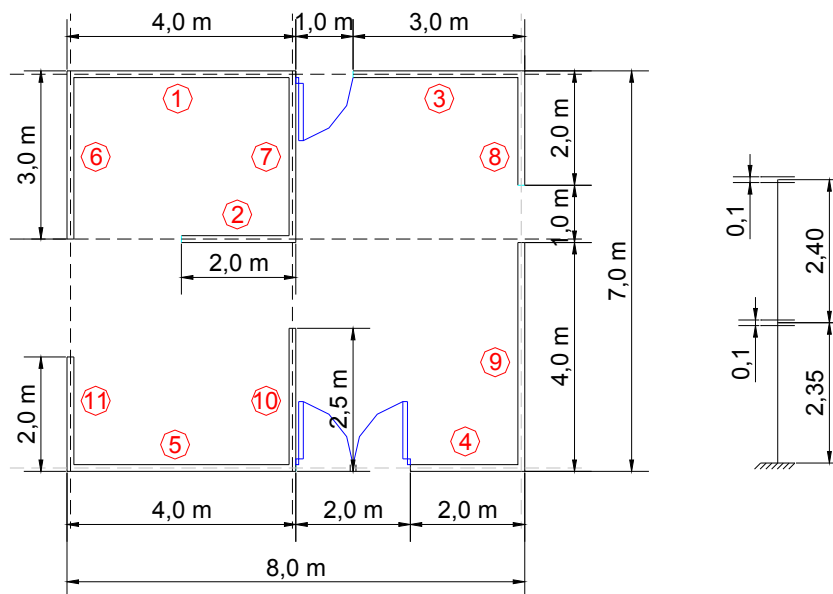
Planta arquitectónica de la distribución de muros en una vivienda típica
